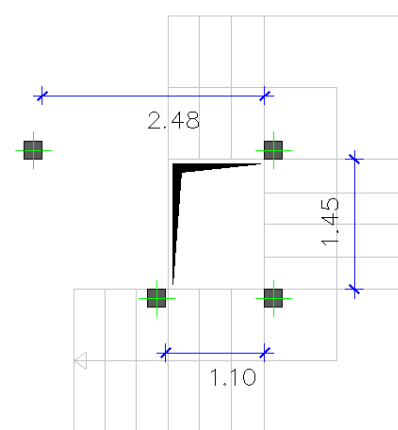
Posicionamento inicial dos pilares da caixa de escada
